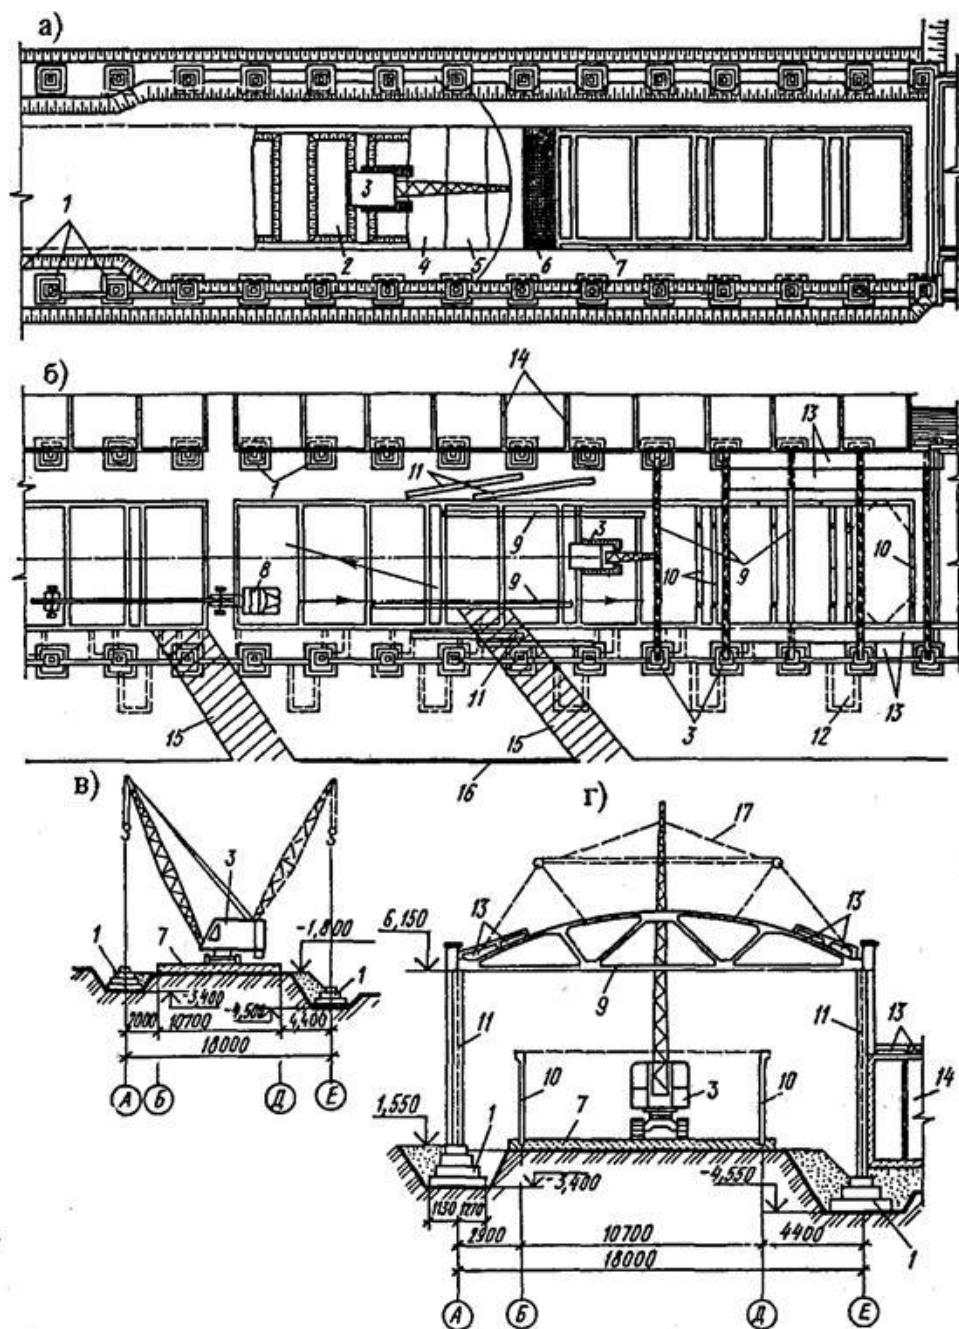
Схема монтажа здания фильтров водоочистной станции:
